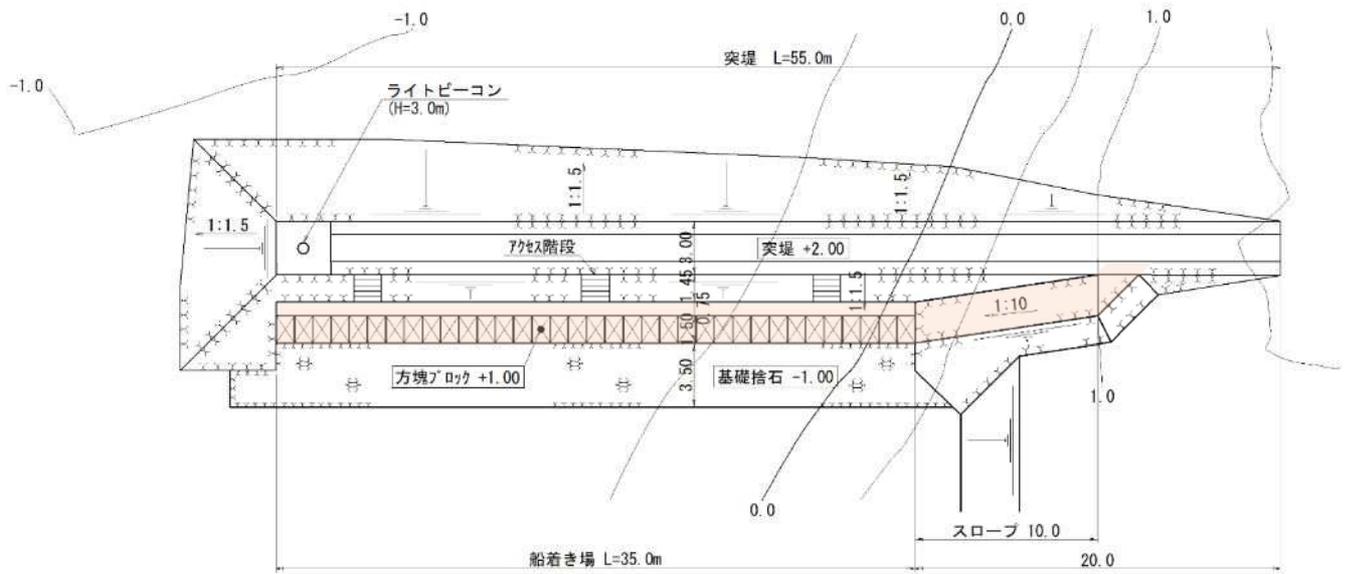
(8) 第2防砂堤(仮設岸壁)の平面図
